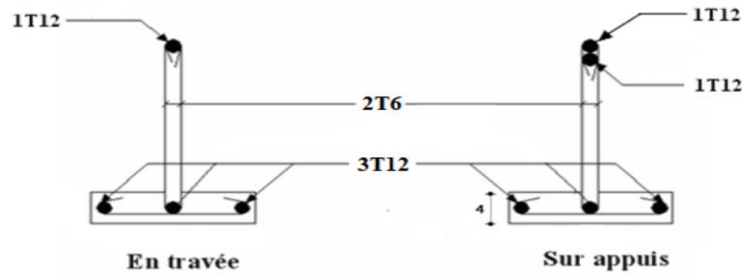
ferrailage des poutrelles en travée et en appuis.
